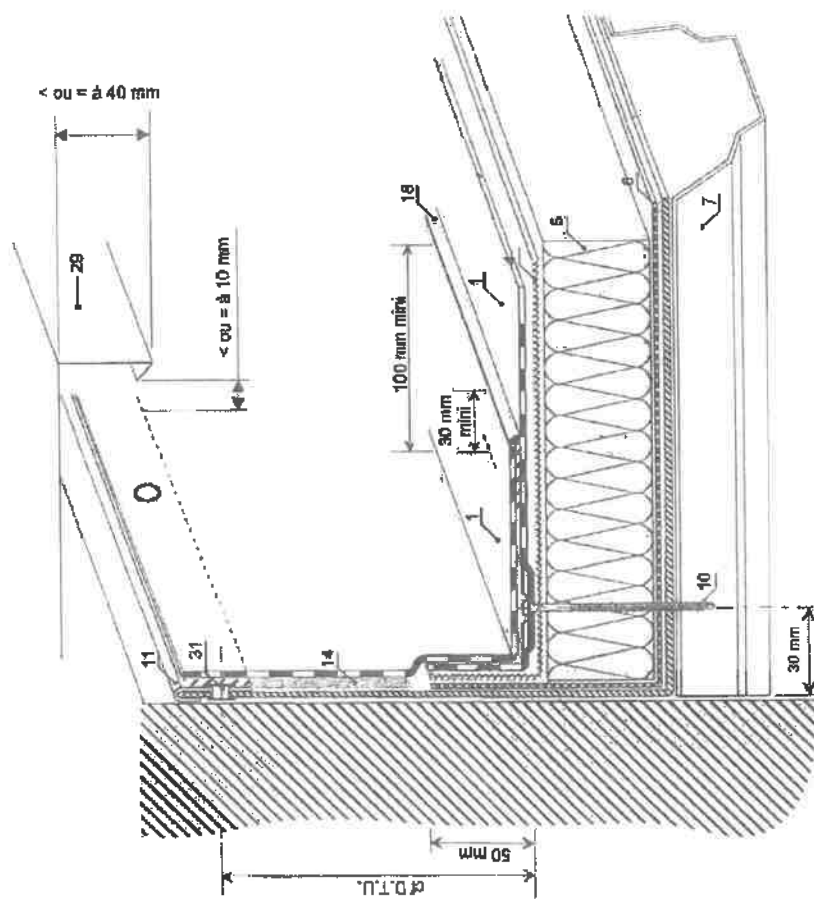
Relevé d'étanchéité - Coupe sur bac acier travaux neufs
